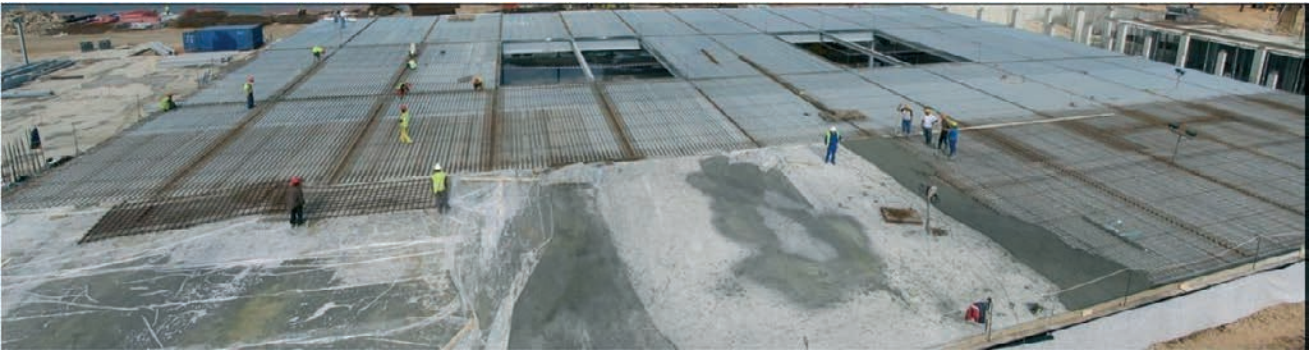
Vista de la cubierta del restaurante durante su ejecución
